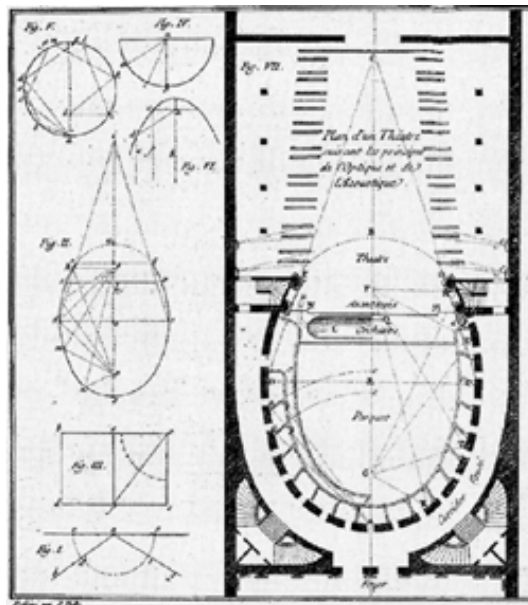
Diseño de planta oval de Pierre Patté.
